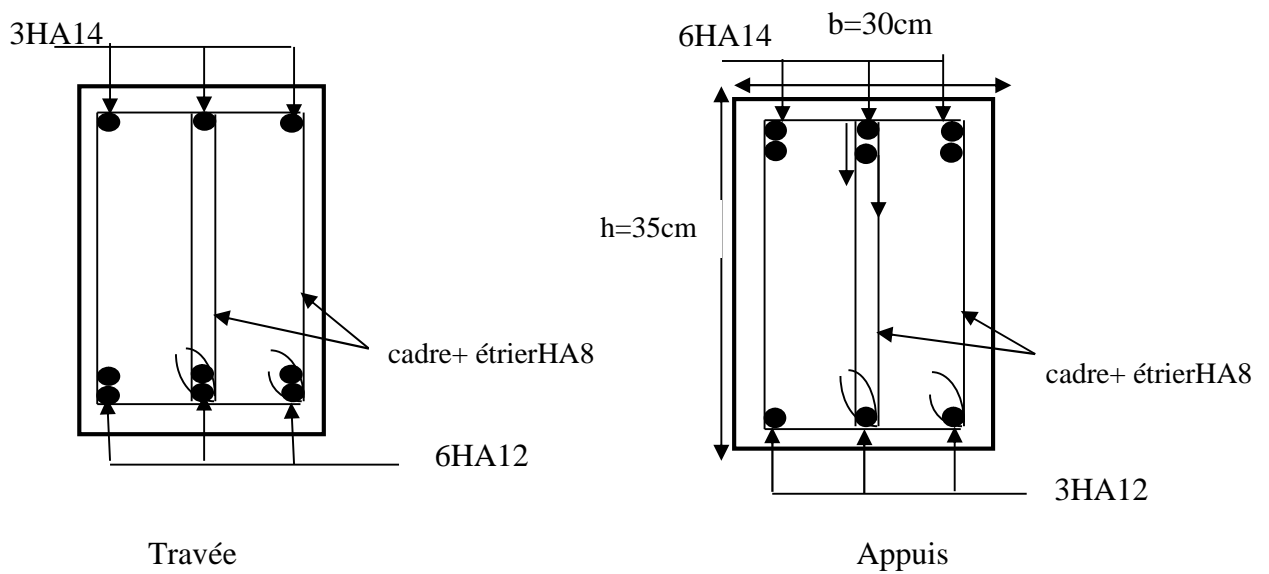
schémas de ferrailage des poutres secondaires étage (6,7,8)
